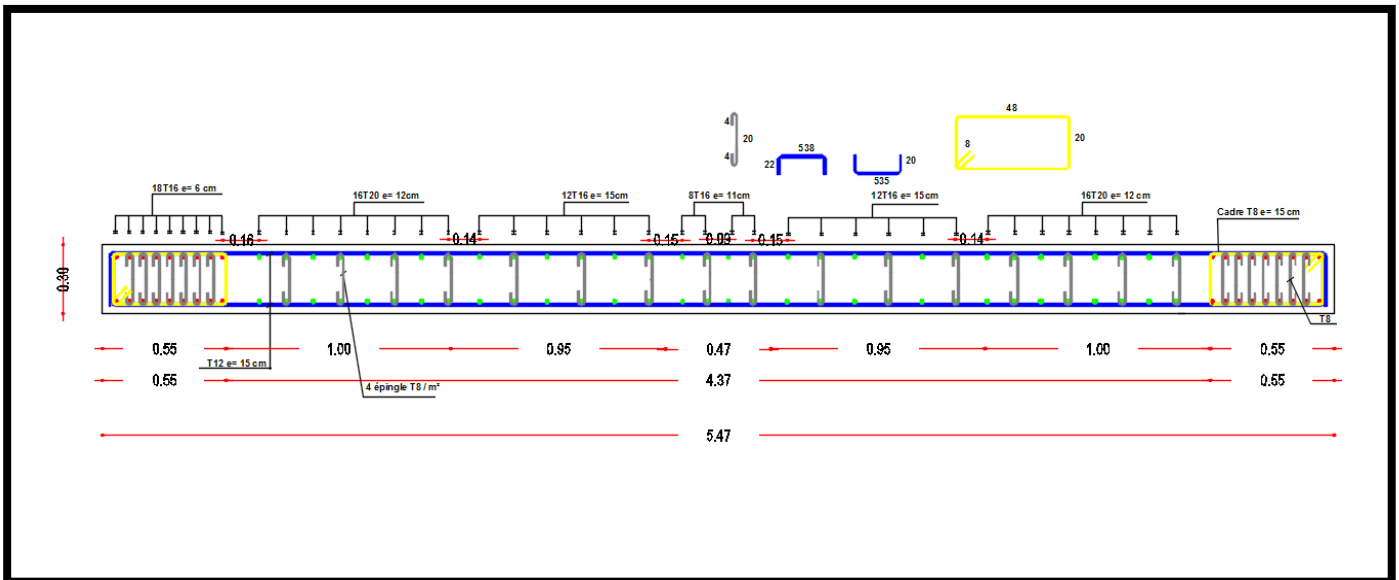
Coupe horizontale du ferrailage des voiles sens Y-Y type (5; 6)
